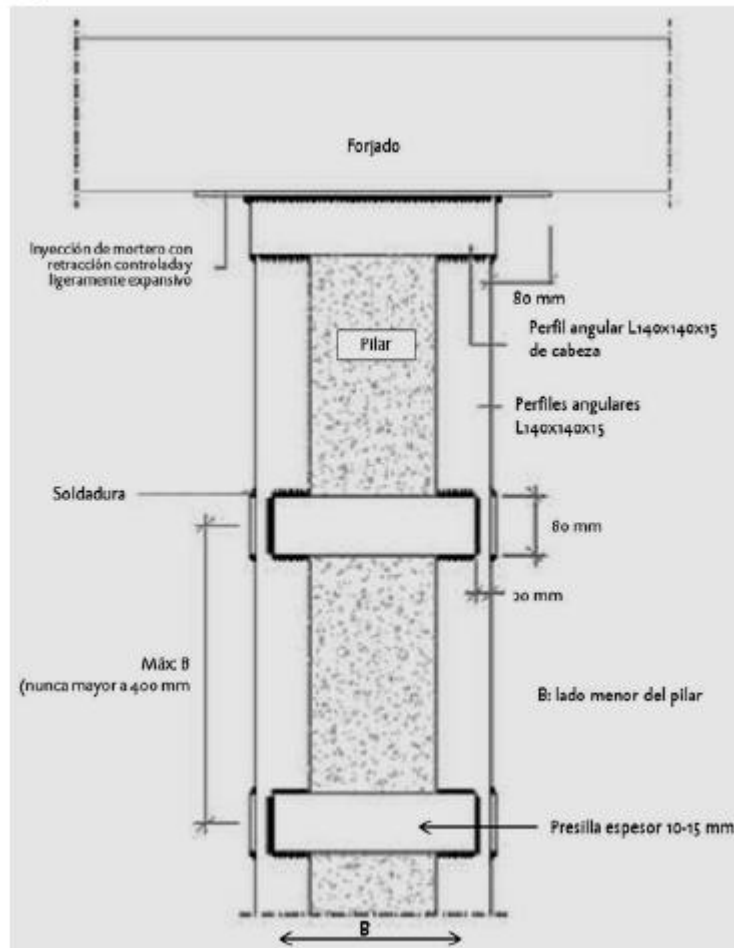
Refuerzo de pilares apantallados con un empresillado metálico.
